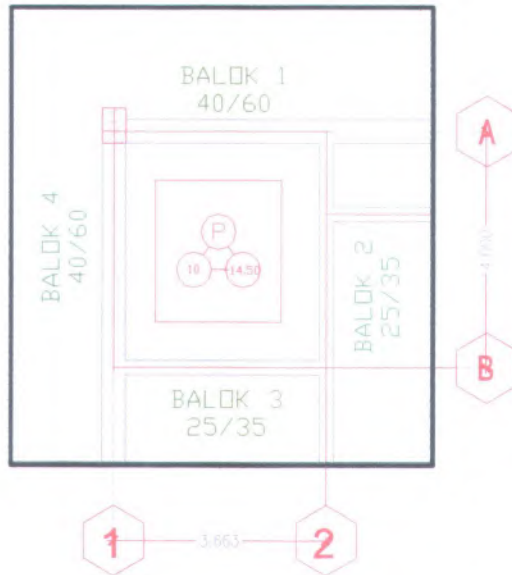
Detail Penulangan Pelat Lantai Tipe A
